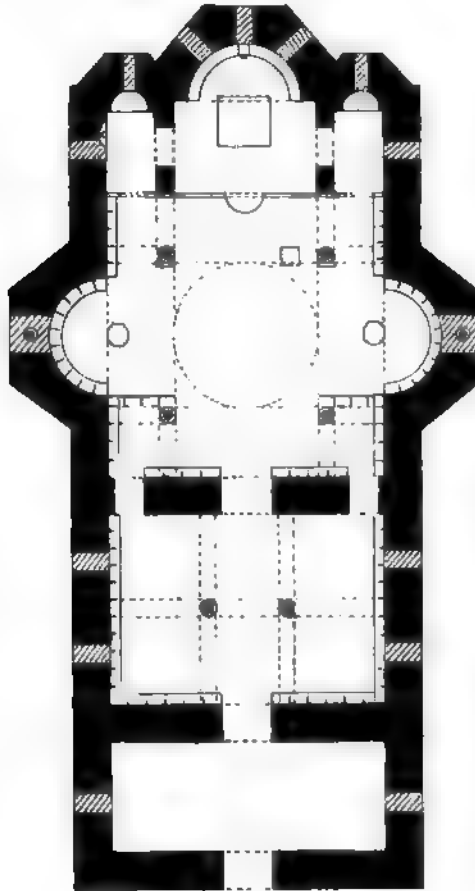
Kirchen-Schema, Grundriss.
